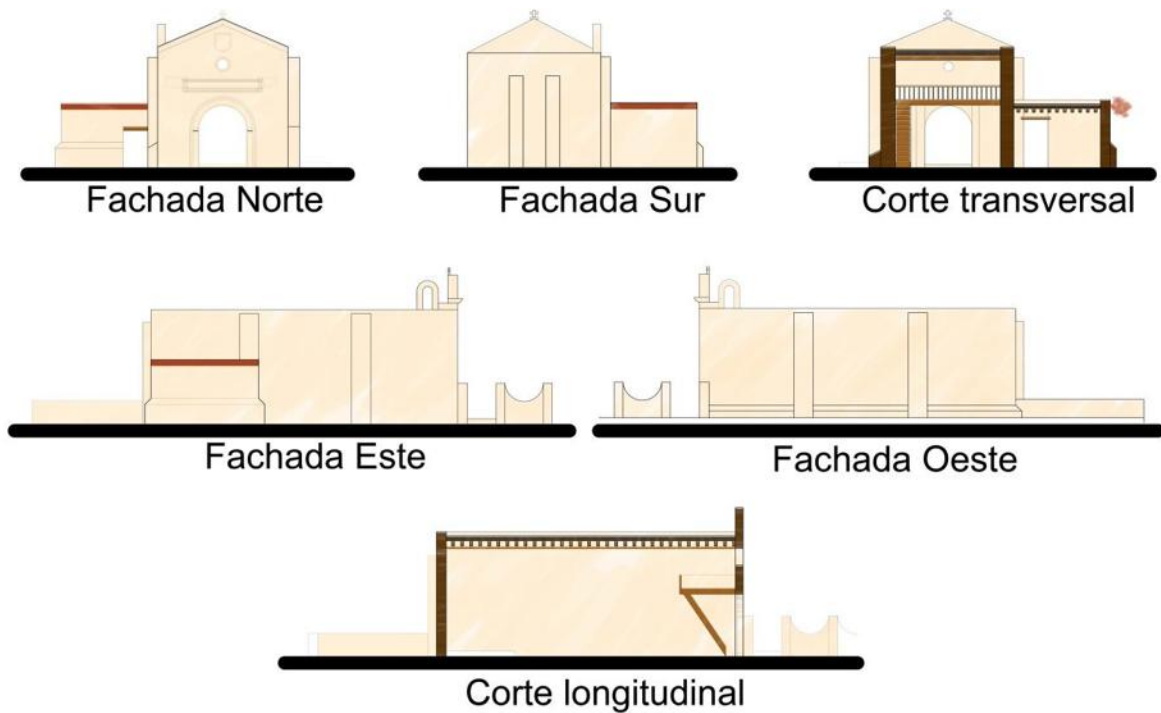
Fachadas y cortes ilustrativos (para ver detalles, ir a planos) - elaborado en Abril de 2012 por Deniss Castañeda
